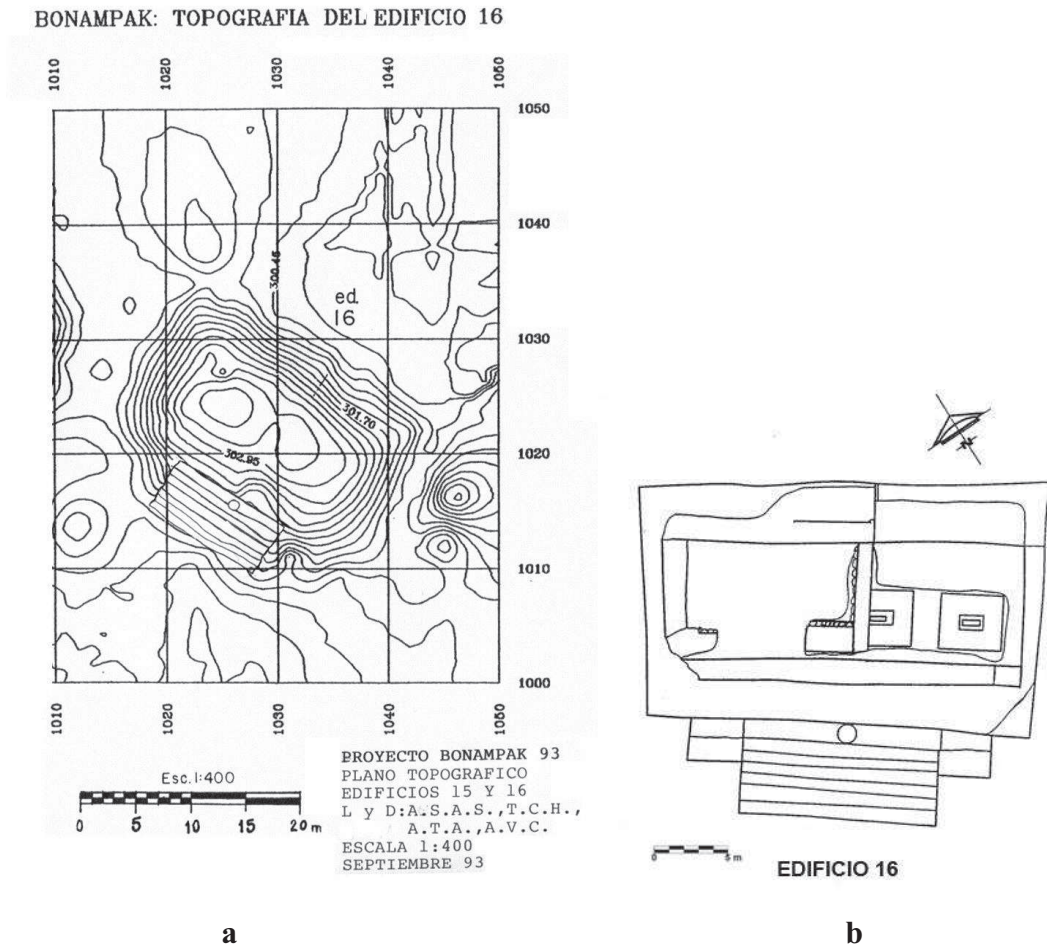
Levantamiento topográfico del edificio 16 antes de su excavación; figura 5.7b, levantamiento arquitectónico al final de la restauración.
